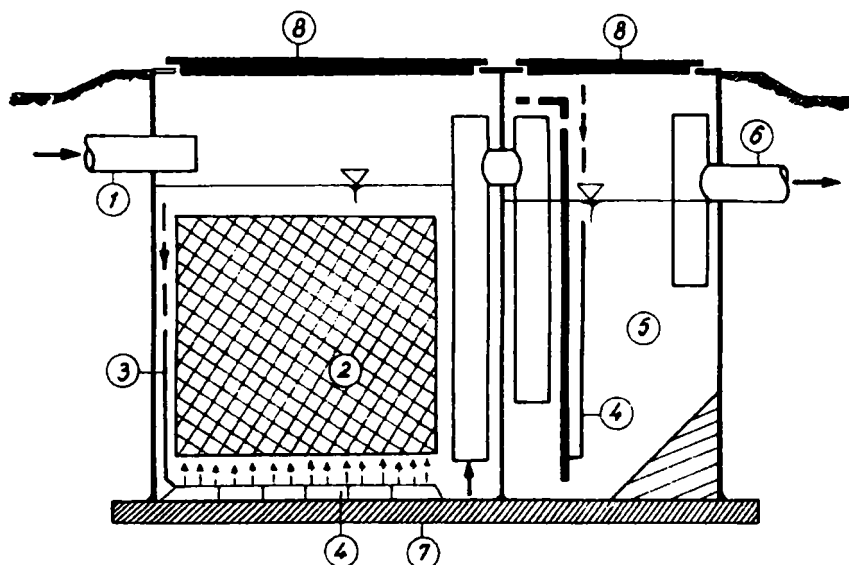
b „Instalație de epurare cu pat aerob scufundat, detalii”
